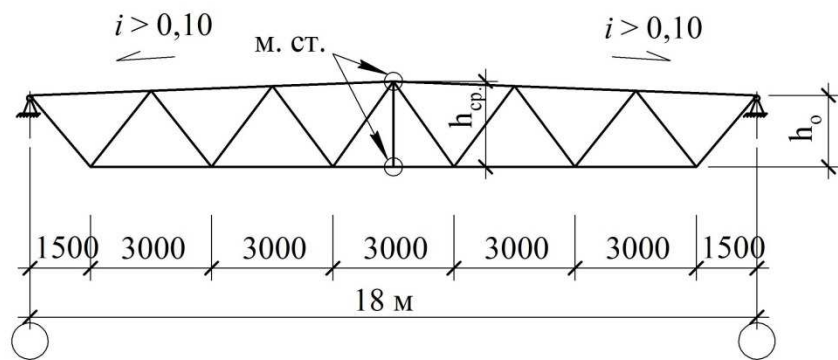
, б – Конструктивная схема стропильных ферм из гнутых профилей с опущенным нижним поясом из гнутых замкнутых профилей пролетом 18 м
